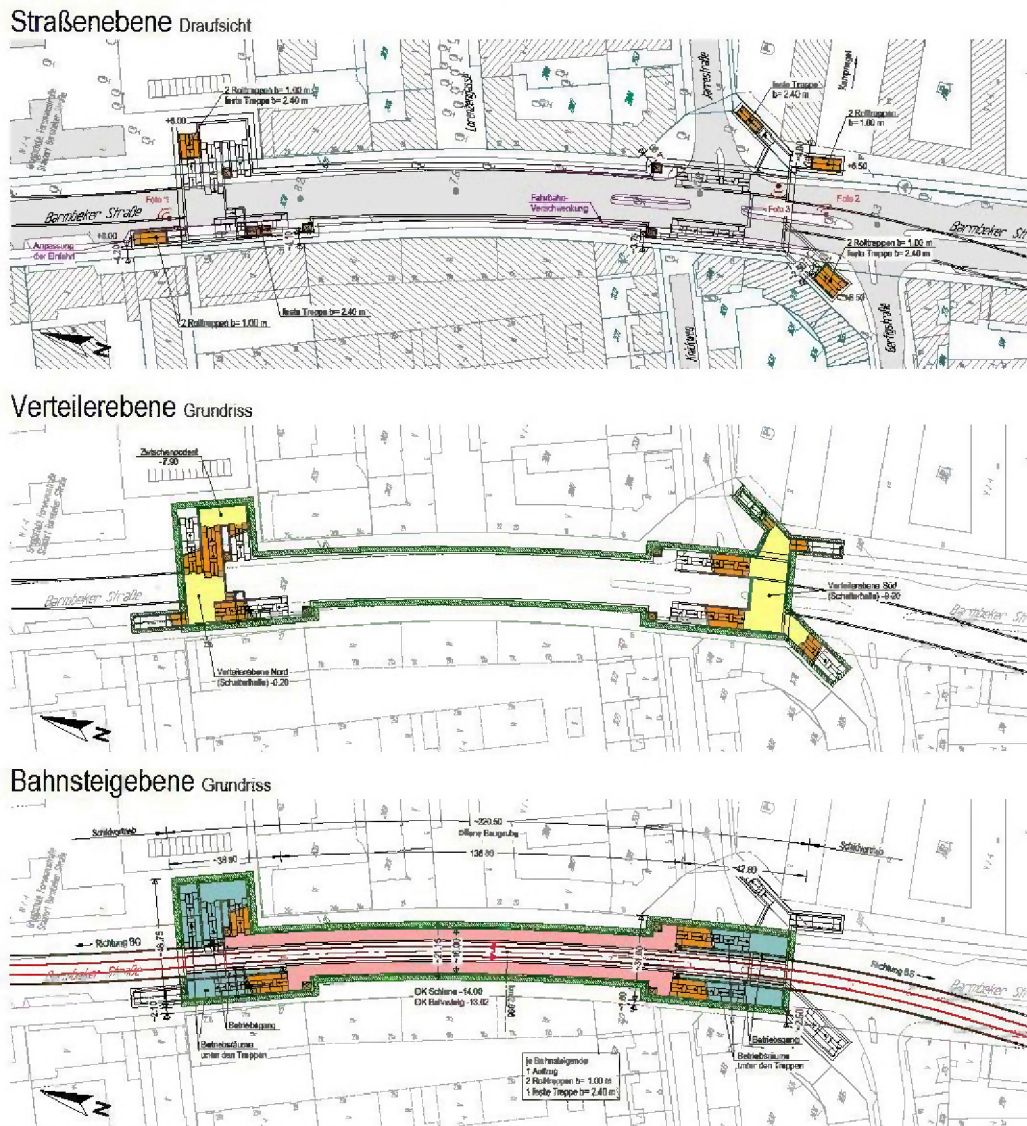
Lageplan Haltestelle Jarrestraße II
